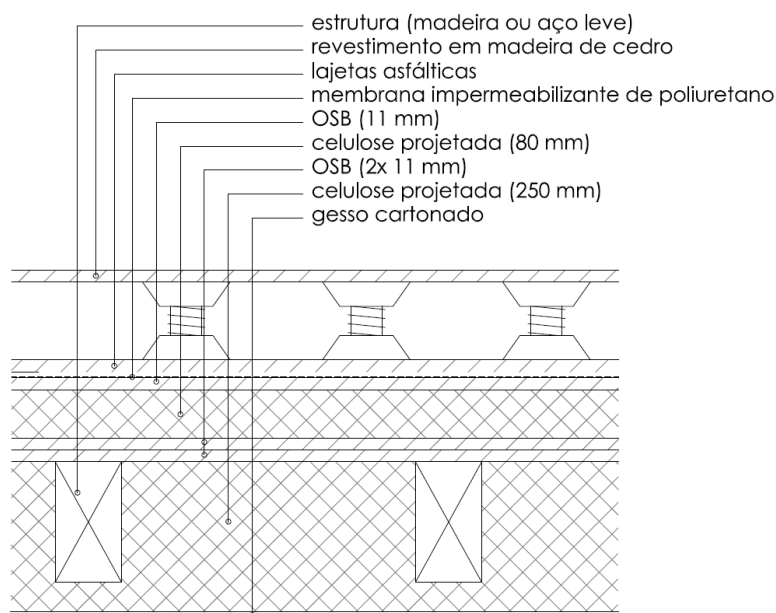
Laje de cobertura em terraço (sem escala)
